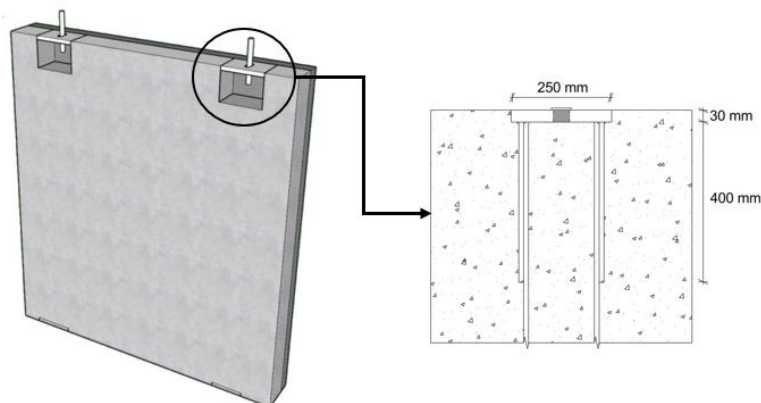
Vista geral da parede prefabricada com ligações secas.
